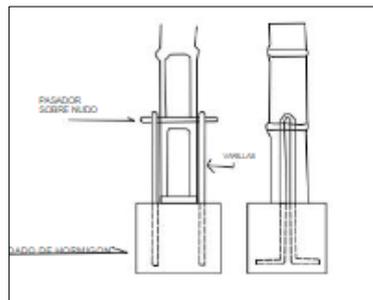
Detalle constructivo para las columnas hechas con caña guadúa.
